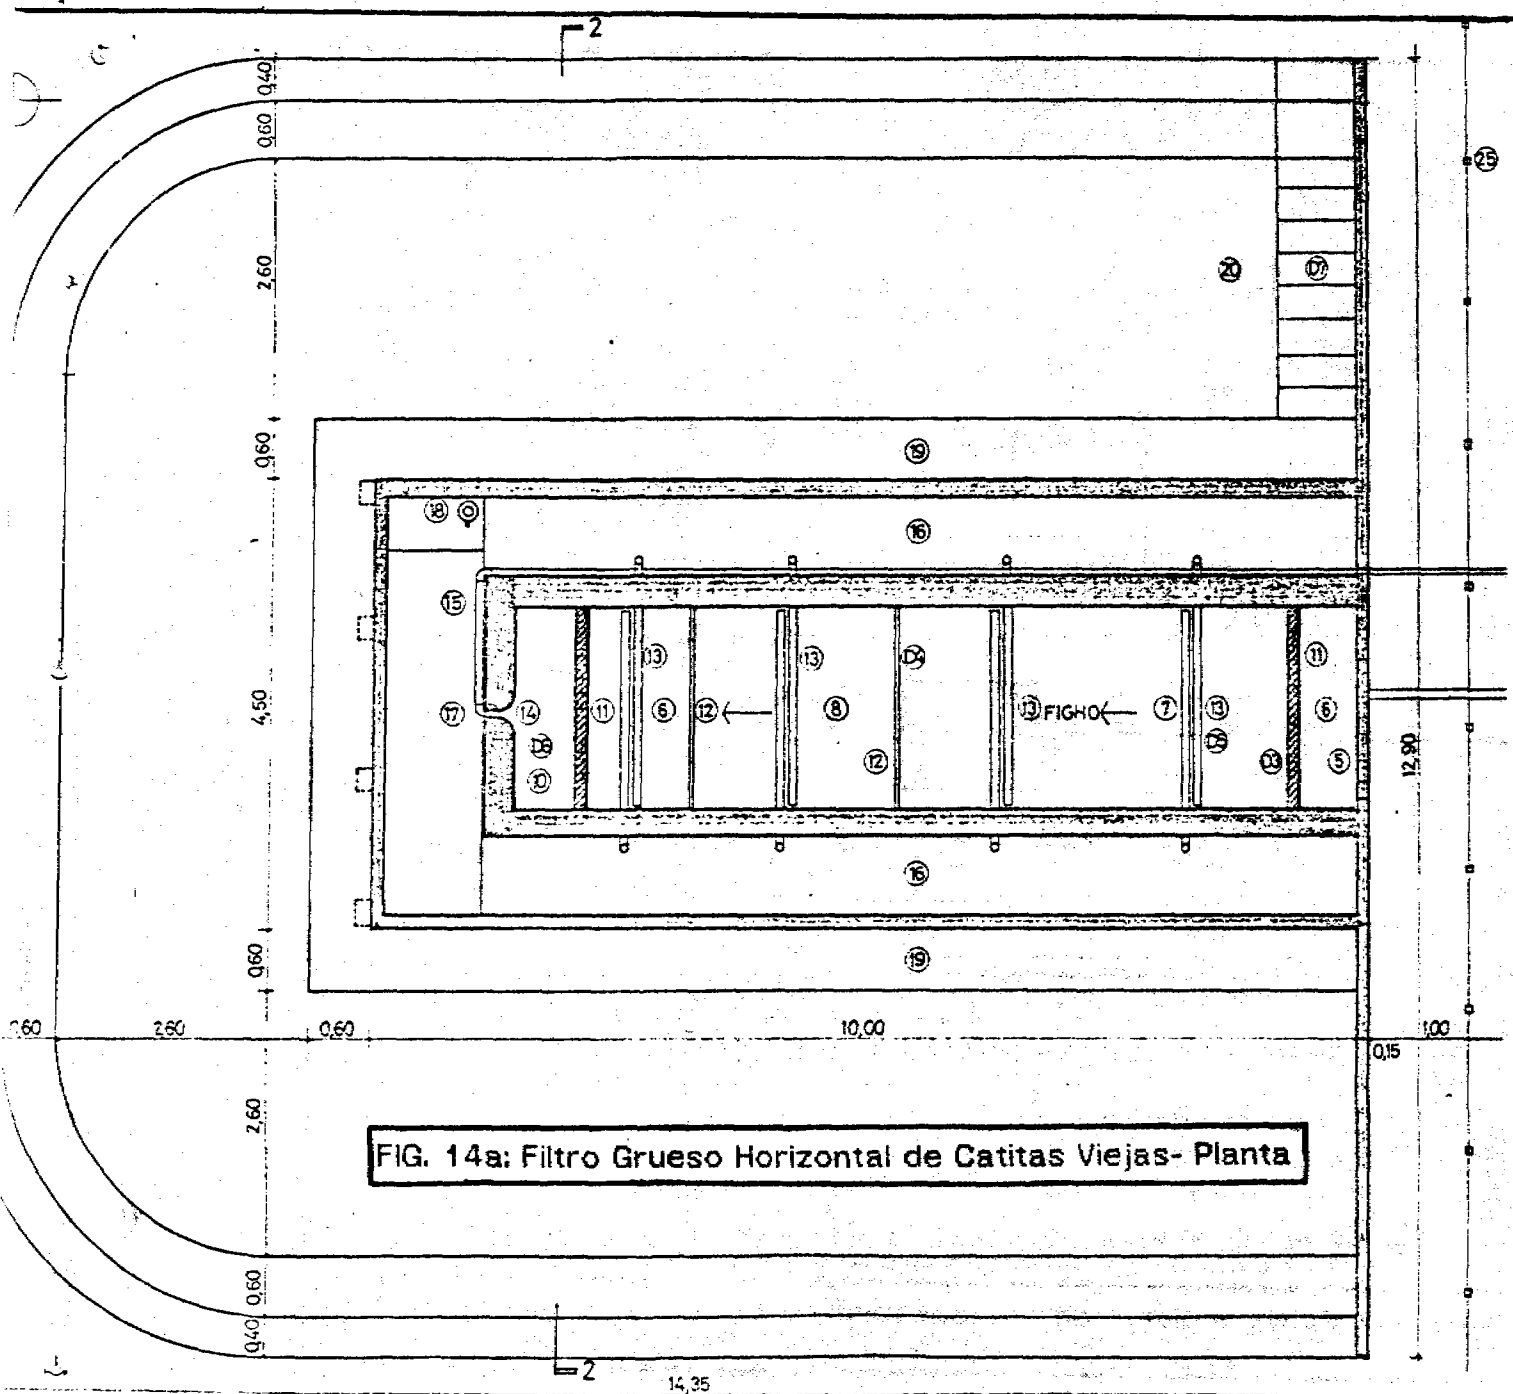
Filtro Grueso Horizontal de Catitas Viejas- Planta
